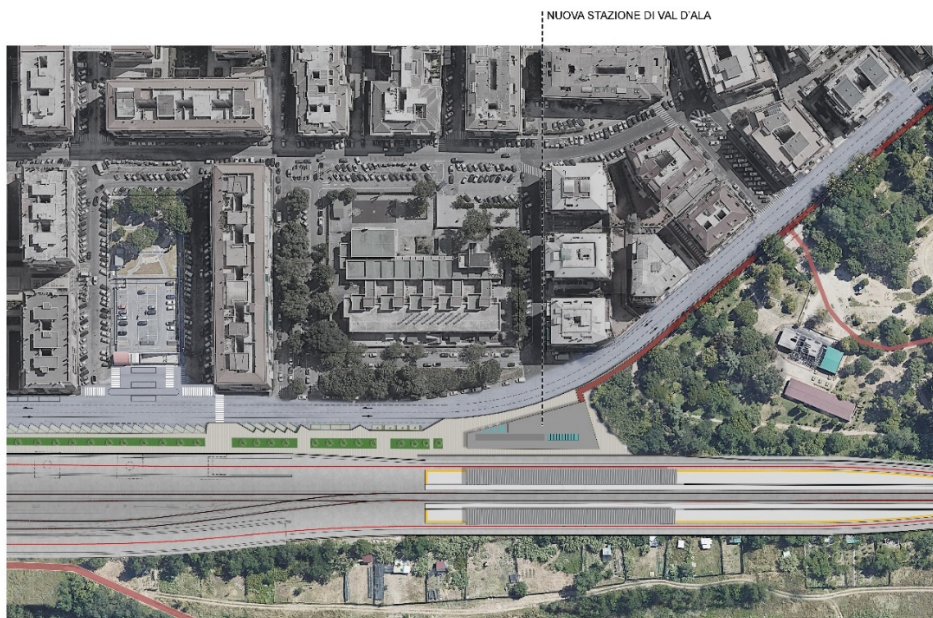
Layout generale di progetto – Stazione di Val D'Ala
